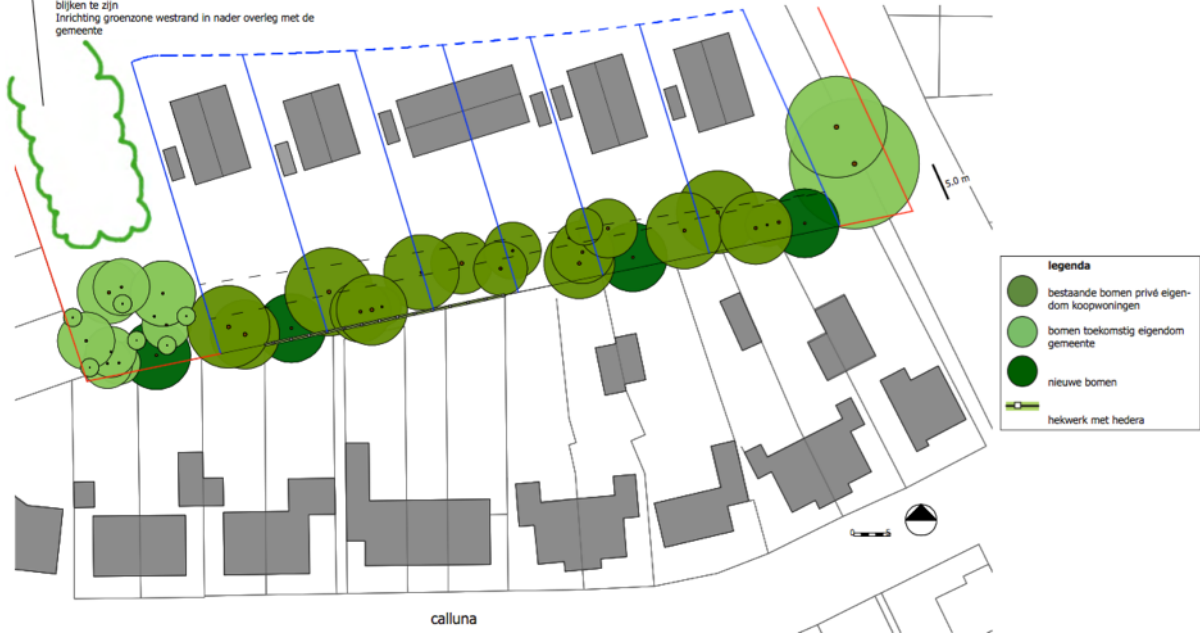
Tekening landschapsplan; bron: EK stedenbouw en landschap
